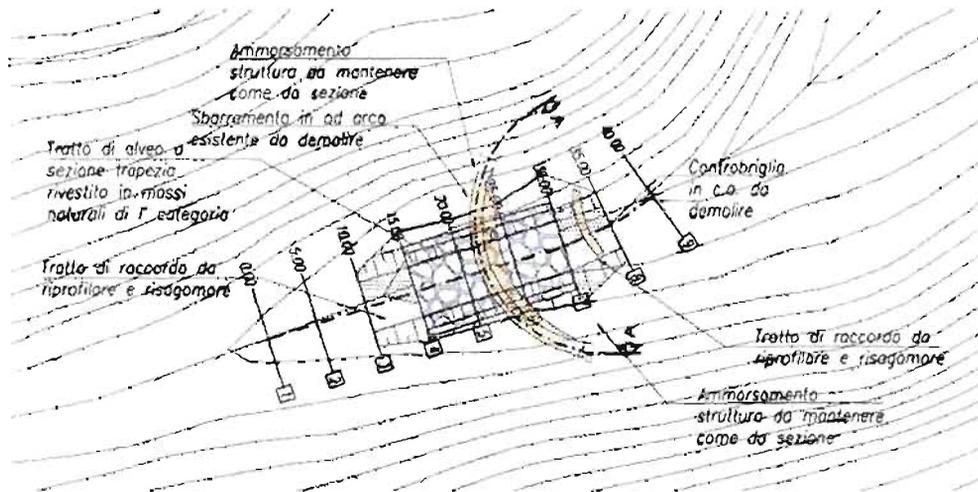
; Planimetria sistemazione idraulica sbarramento SA02
